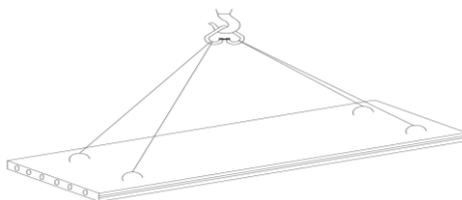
Схема строповки пустотной плиты перекрытия
